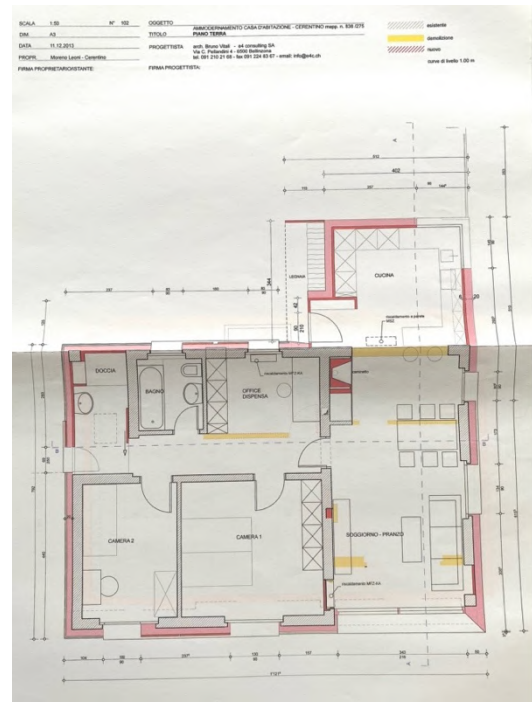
Grundriss mit Lageplan der Inneneinheiten
